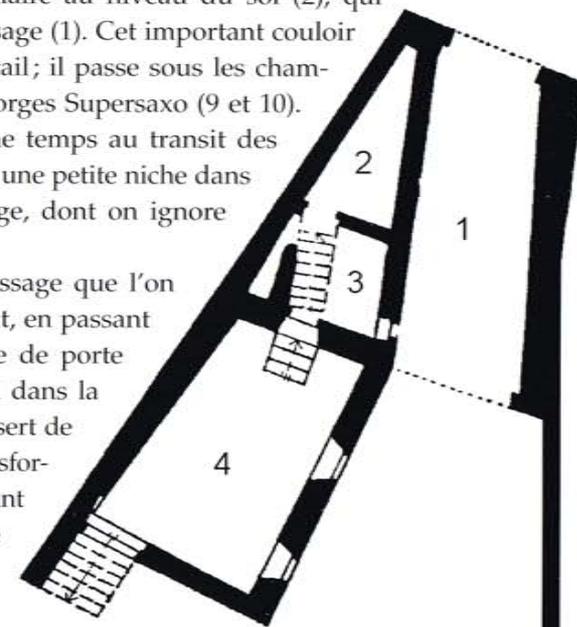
Plan des fondations et de la cave du XVI^e siècle.
